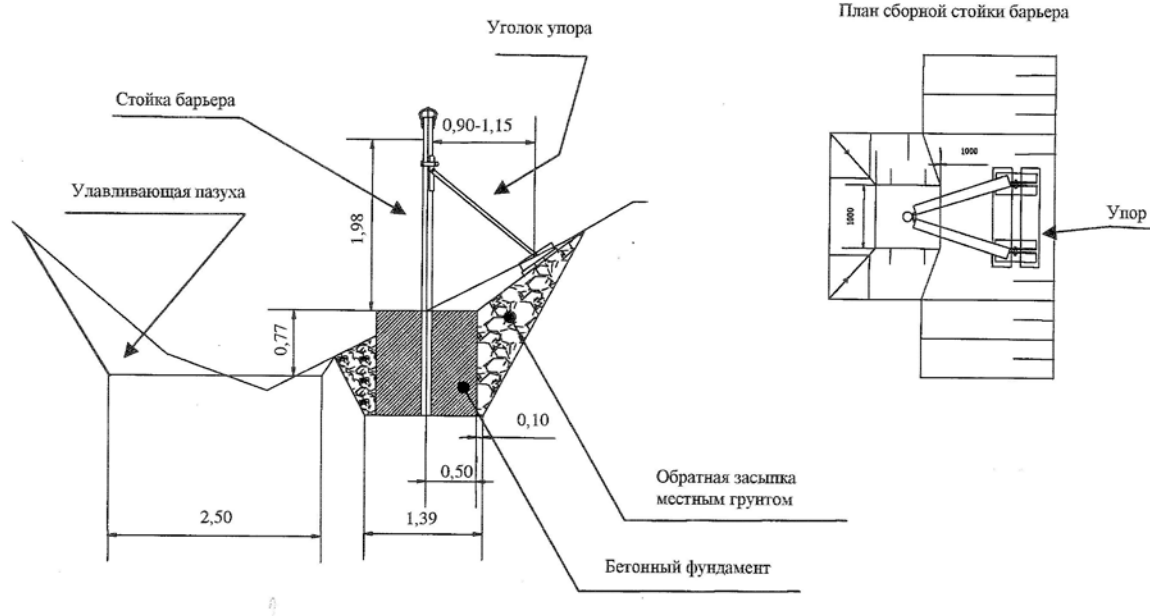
Пример сетчатого защитного барьера на фундаменте вариант 1 НПО Геомостпроект
